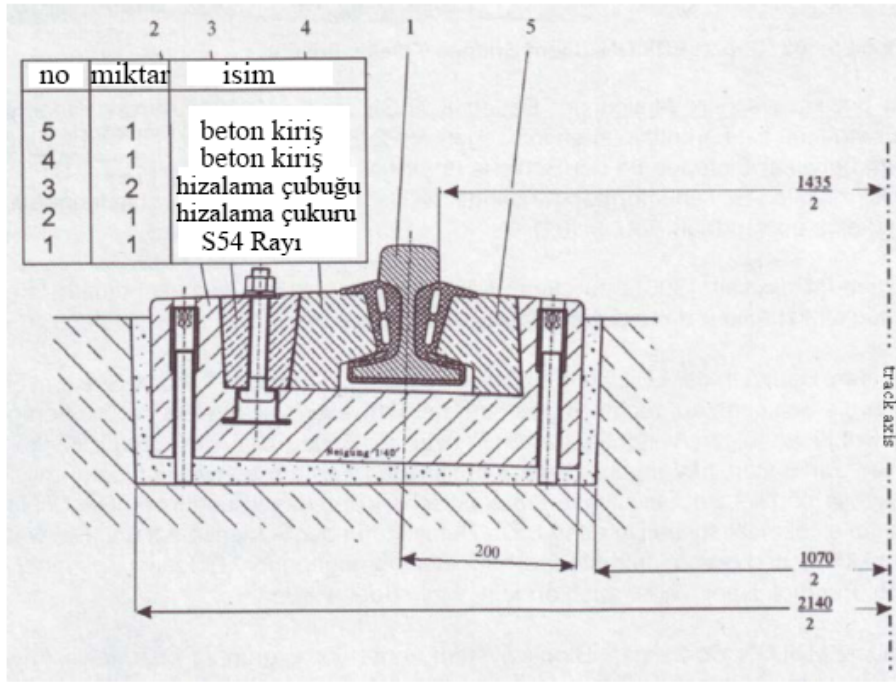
BBERS üstyapı sisteminin en kesiti.
